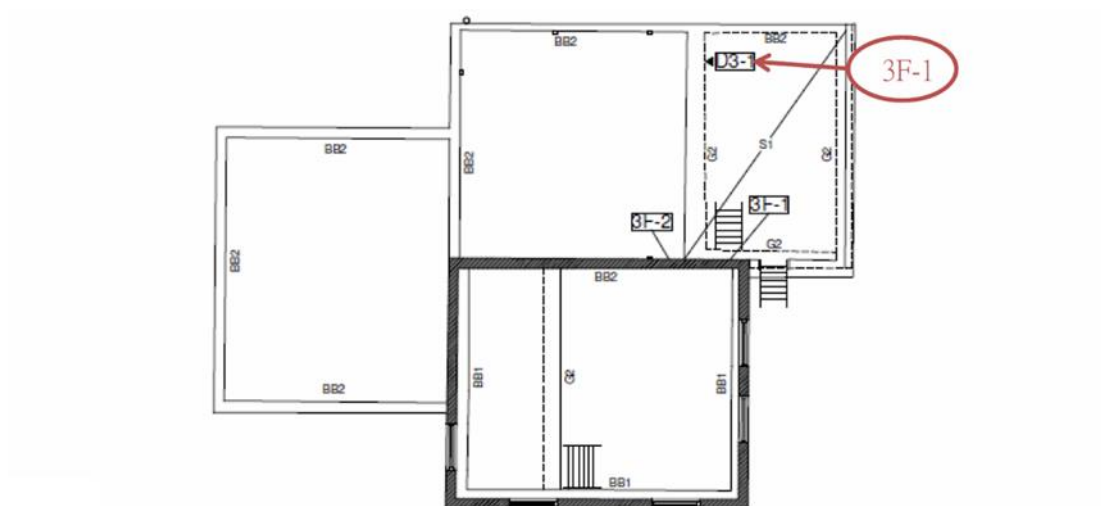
混凝土鑽心取樣位置圖（3F）
